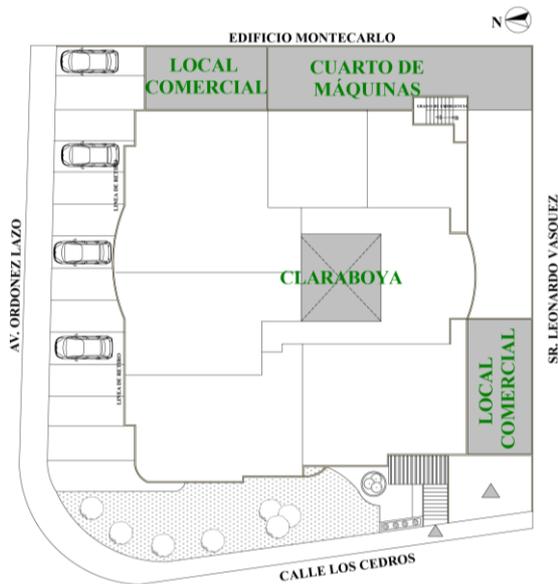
Estudio de ingreso de luz natural en la planta arquitectónica.
